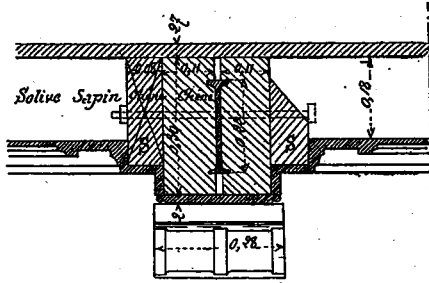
Coupe suivant CD du plan (fig. 317).
